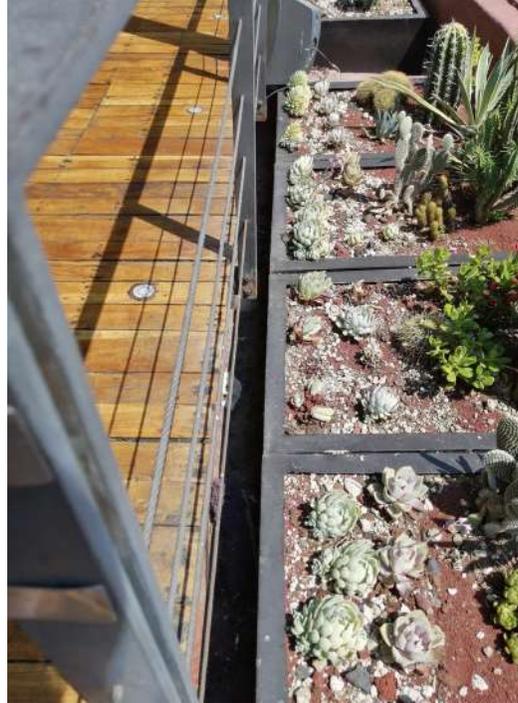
Detalle final piso falso de madera y piso original cubierto por jardineras
